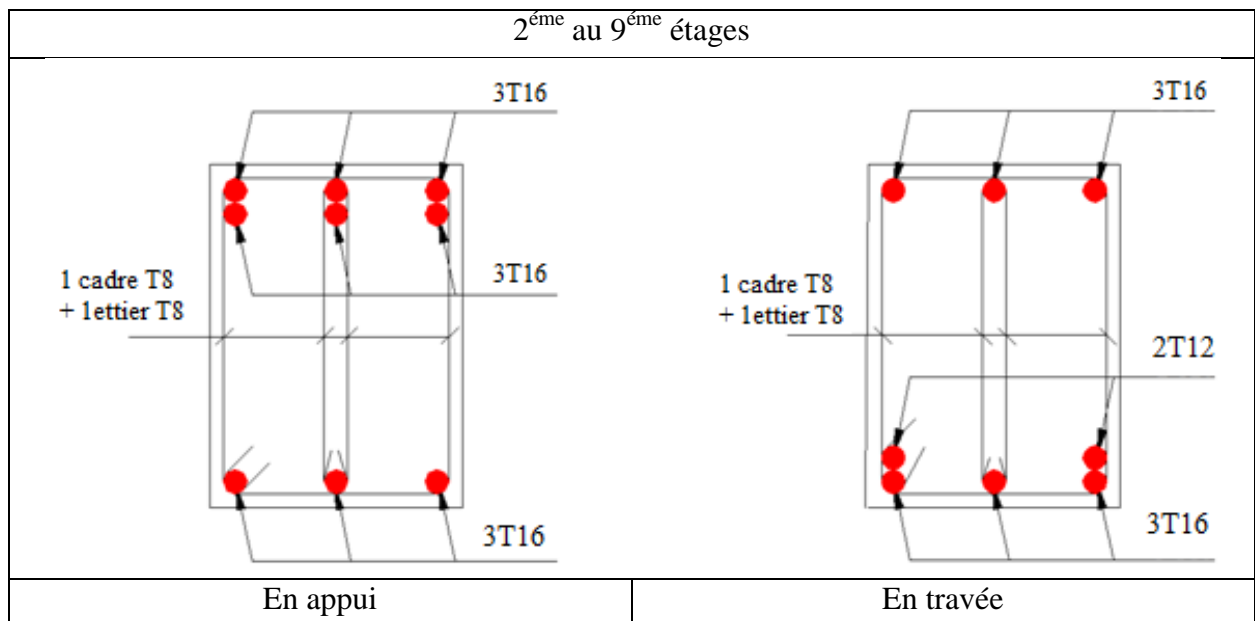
Ferraillage des Poutres porteuses 2^{ème} au 9^{ème}
